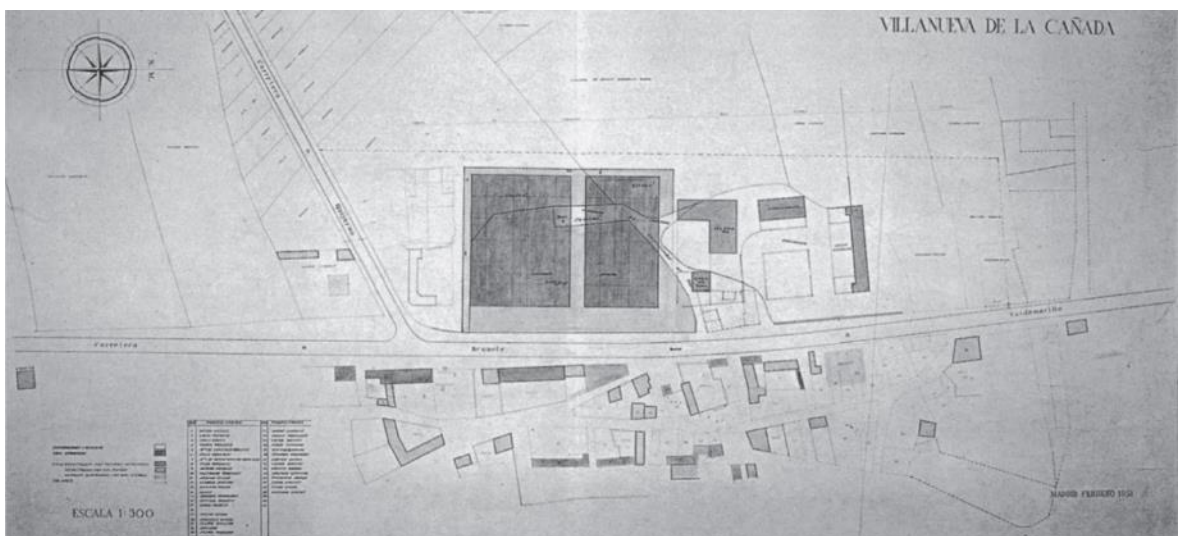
Proyecto de ordenación definitiva. 1951. Fuente: Archivo General de la Administración.
